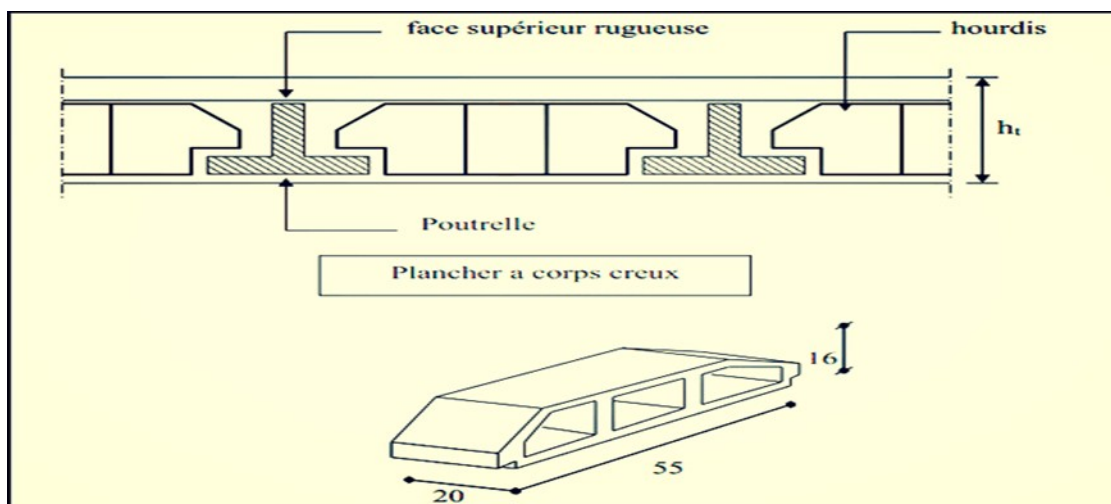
Schéma d'un plancher en corps creux.III.5.2. Etude et ferrailage de la dalle de compression : [BAEL 91/B.6.8,423]
